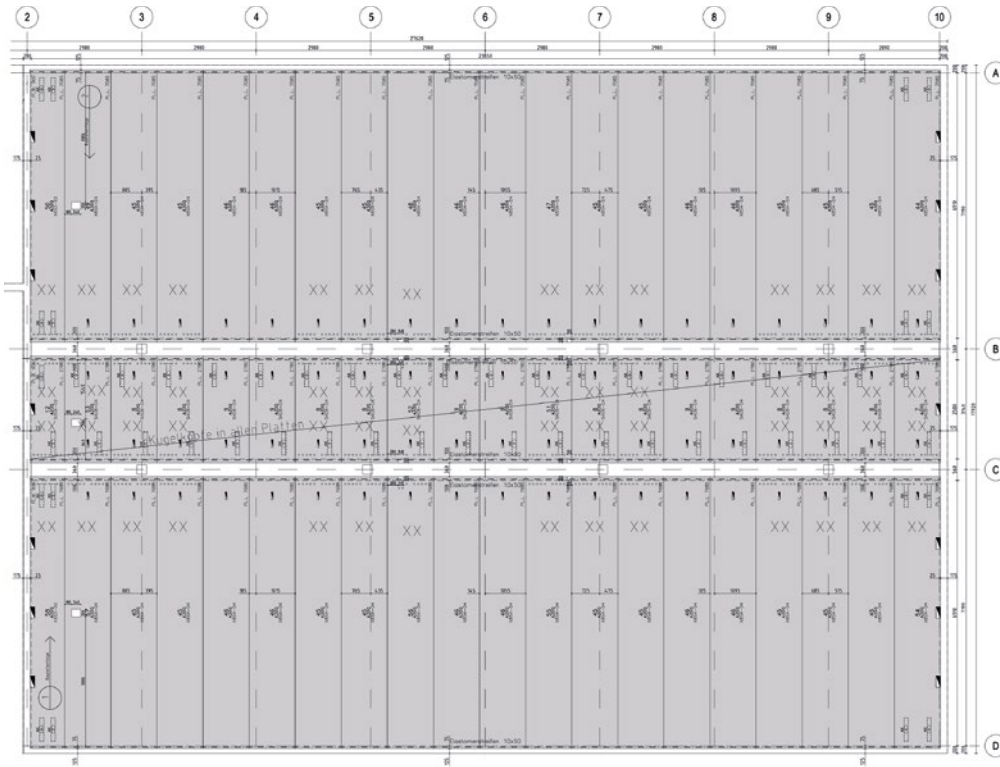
Ausschnitt EG-Deckenverlegeplan von DW SYSTEMBAU, Vizelinstraße in Hamburg (DW Systembau GmbH)
